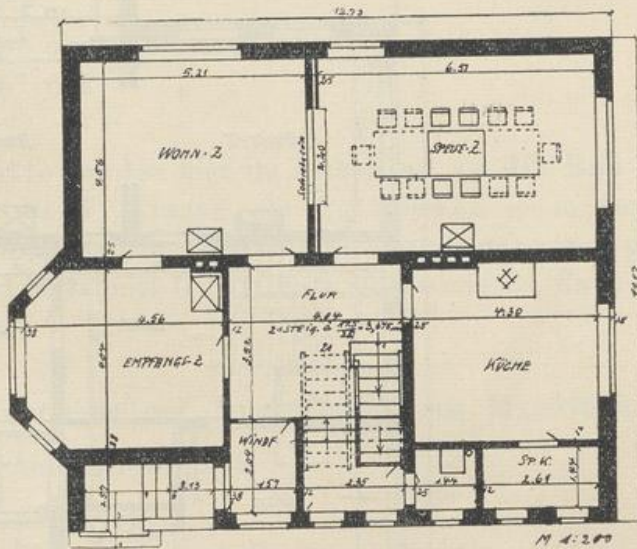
Herschaftliches Wohnhaus. Empfangszimmer neben Windfang. Wohnzimmer und Speisezimmer mit Schiebetür verbunden. Alle Zimmer unter sich und mit dem Flur durch Türen verbunden. Größere Geschoßhöhe = 3,675 m. 3 Zimmer im Erdgeschoß.
